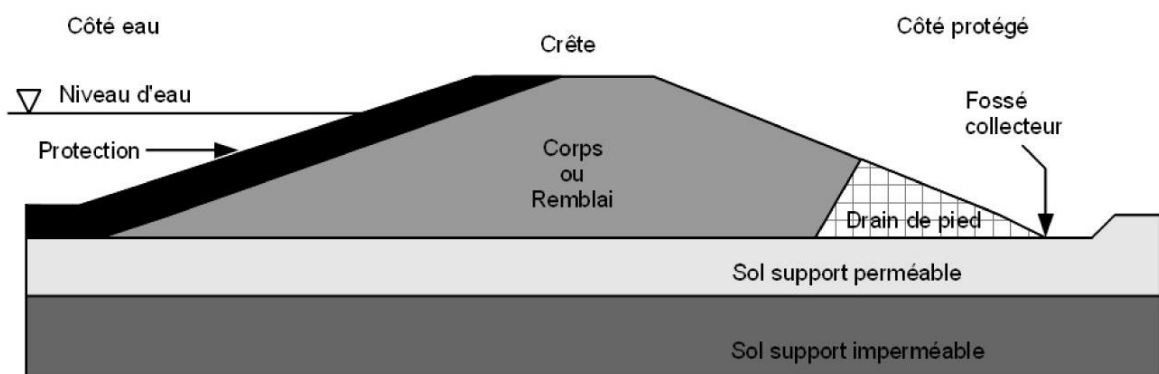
Digue homogène sur fondation perméable sans ancrage étanche
